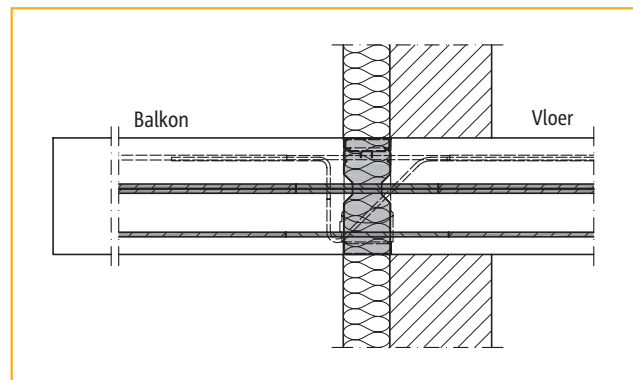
Bovenaanzicht ondersteund balkon met Schöck Isokorb® type Q+Q en EQ-module
